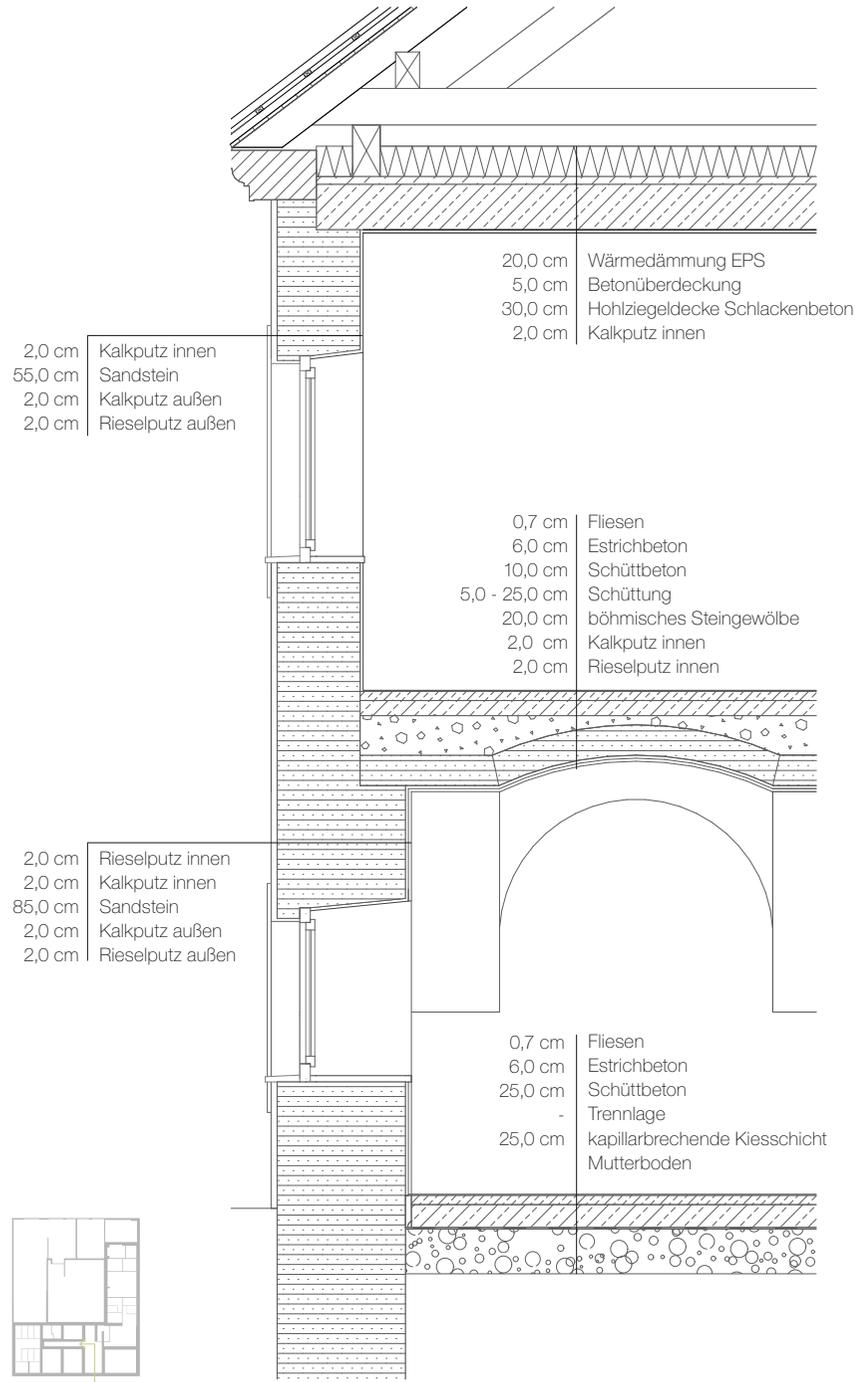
| Fassadenschnitt Bestand | M 1:50
